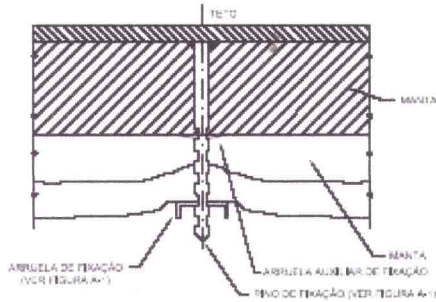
DETALHE DE FIXAÇÃO DO PINO DE FIXAÇÃO.
